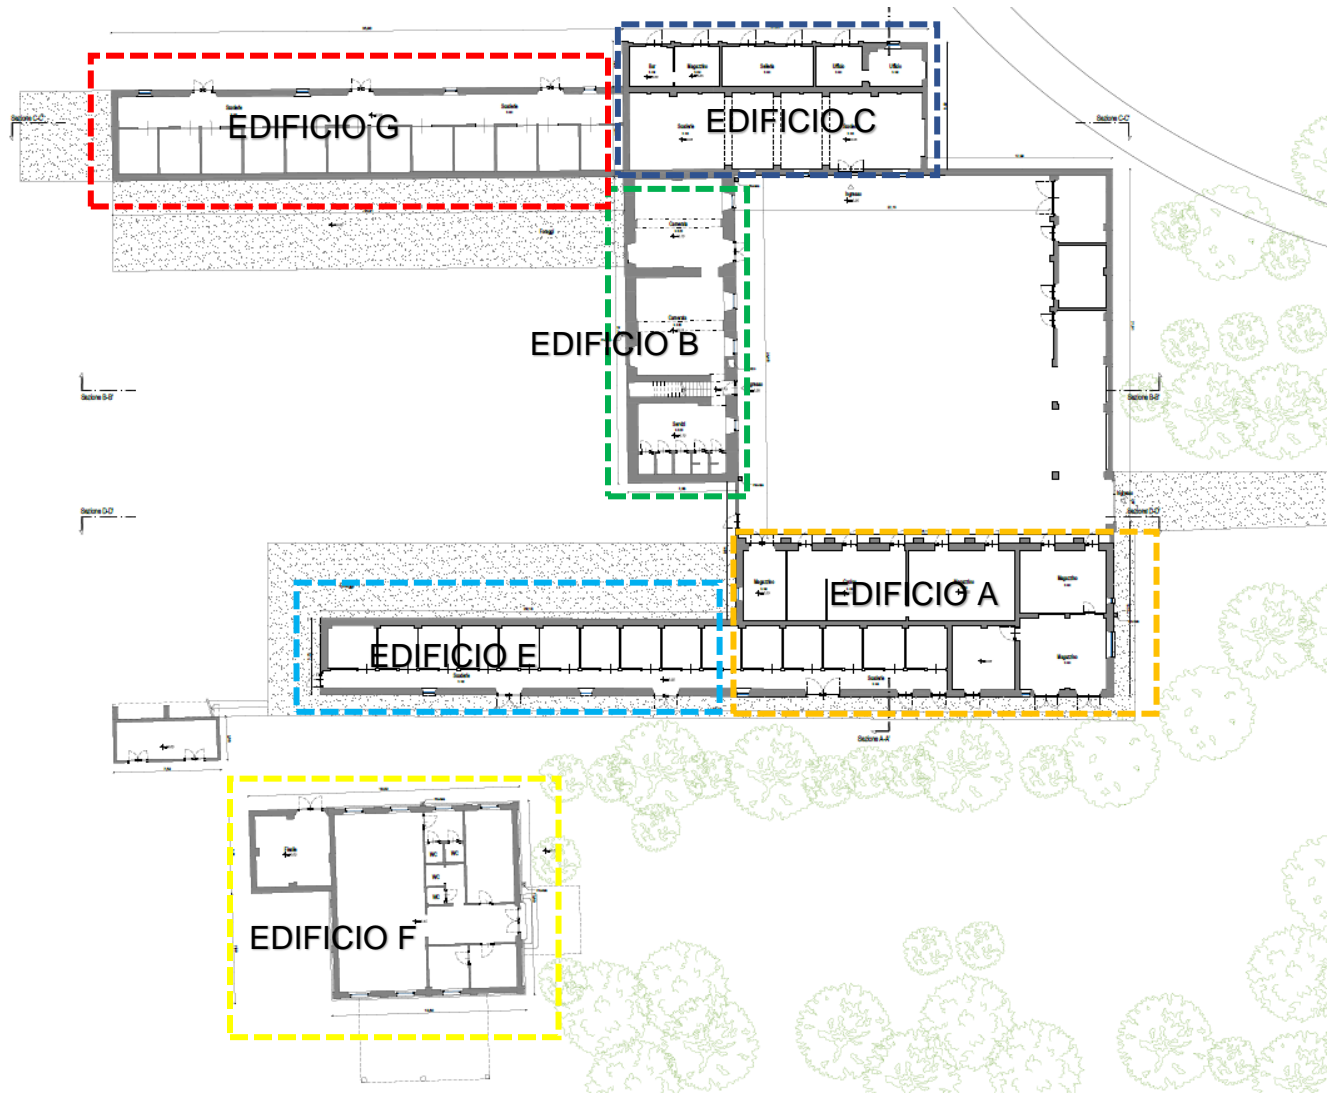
Ex Galoppatoio – planimetria stato di fatto
